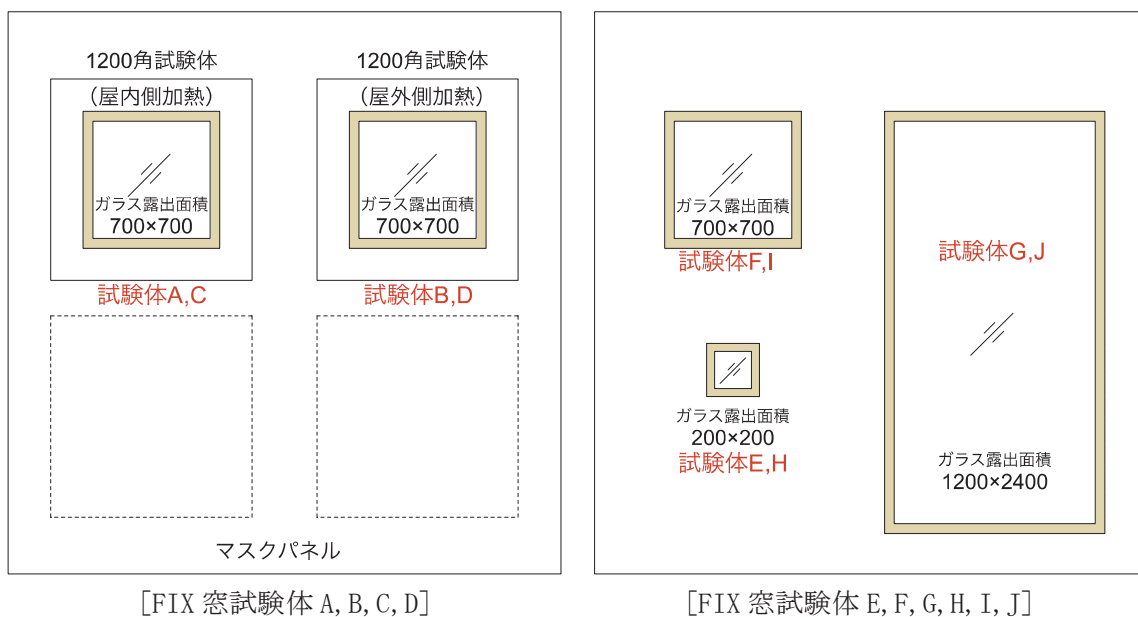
試験体概要(FIX 窓) (寸法単位 : mm)
